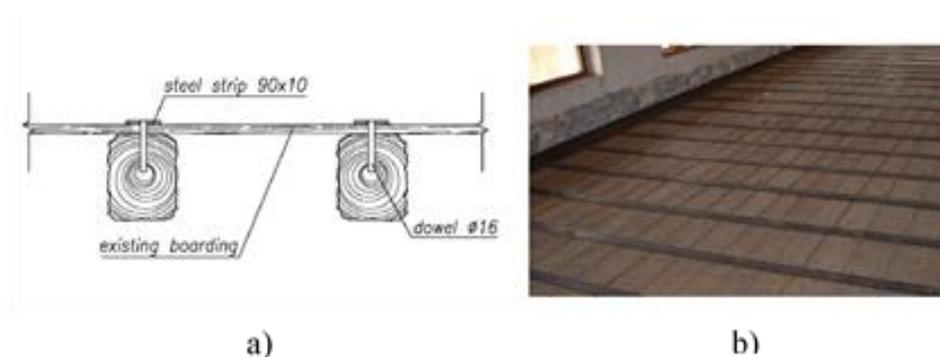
a) Reforço através da colocação de chapas metálicas sobre as vigas (corte transversal), b) Exemplo prático de aplicação da solução num pavimento de madeira (Gattesco, 2006)
